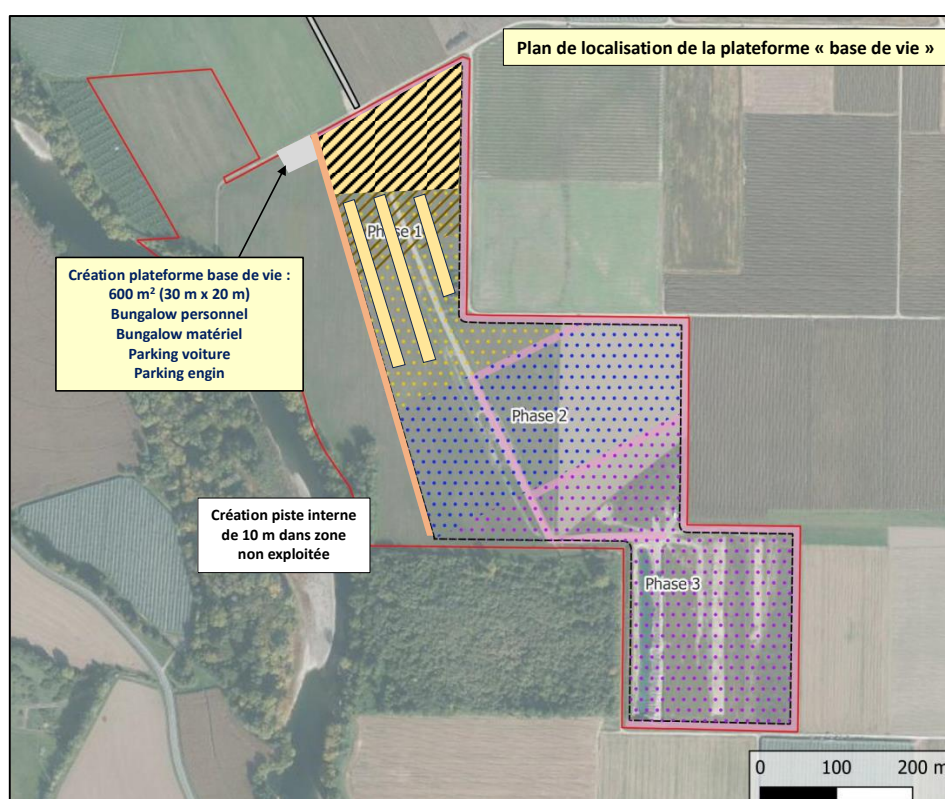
Plan de localisation de la plateforme « Base de vie »
